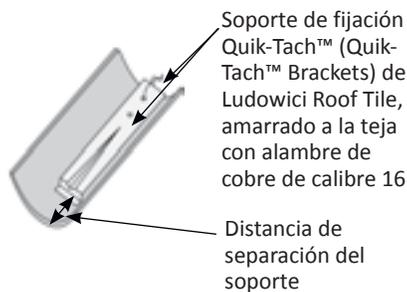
La teja de reemplazo con soporte de fijación Quik-Tach™ (Quik-Tach™ Bracket)
